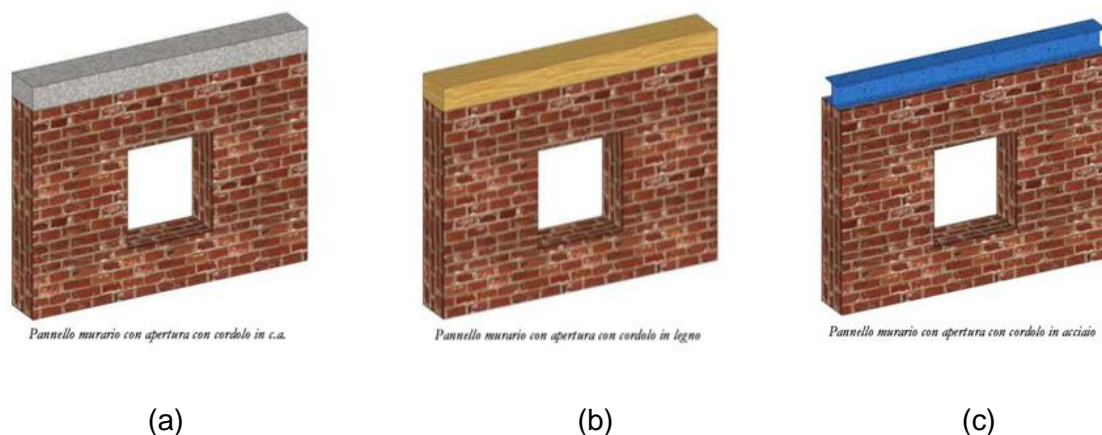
Paredes de mampostería con abertura y vigas de atado de: (a) hormigón armado, (b) madera y (c) acero en 3muri Fuente: S.T.A Data (2018).
